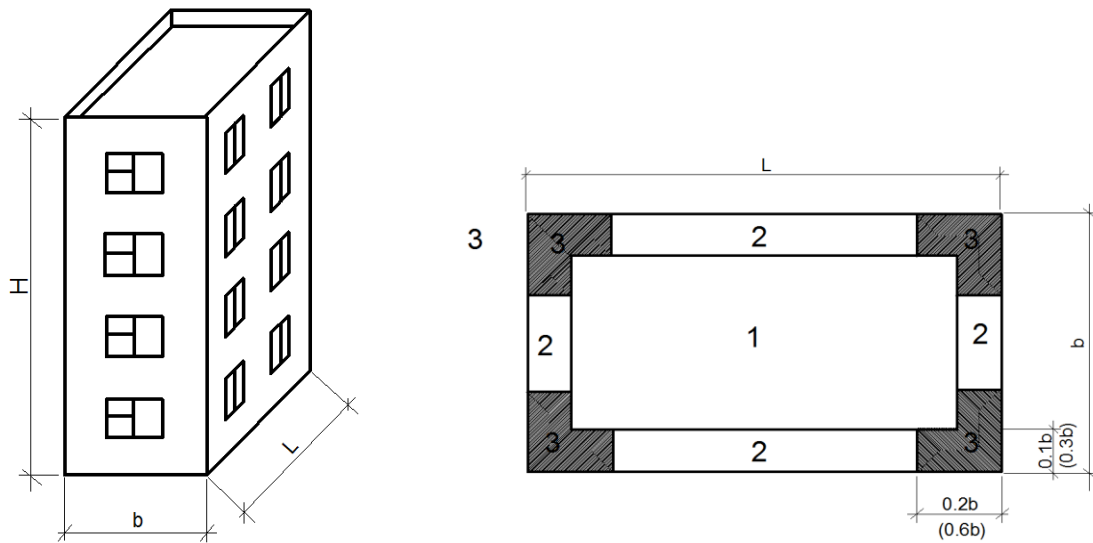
Зоны аэродинамического коэффициента c на кровле с парапетом
